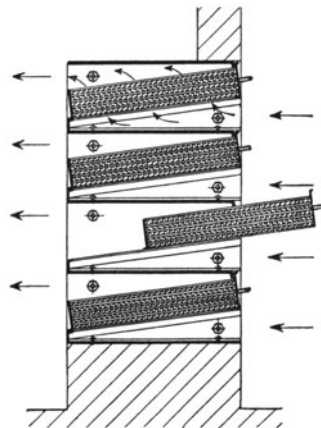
Filterwand mit schräg eingebauten Kästen.
